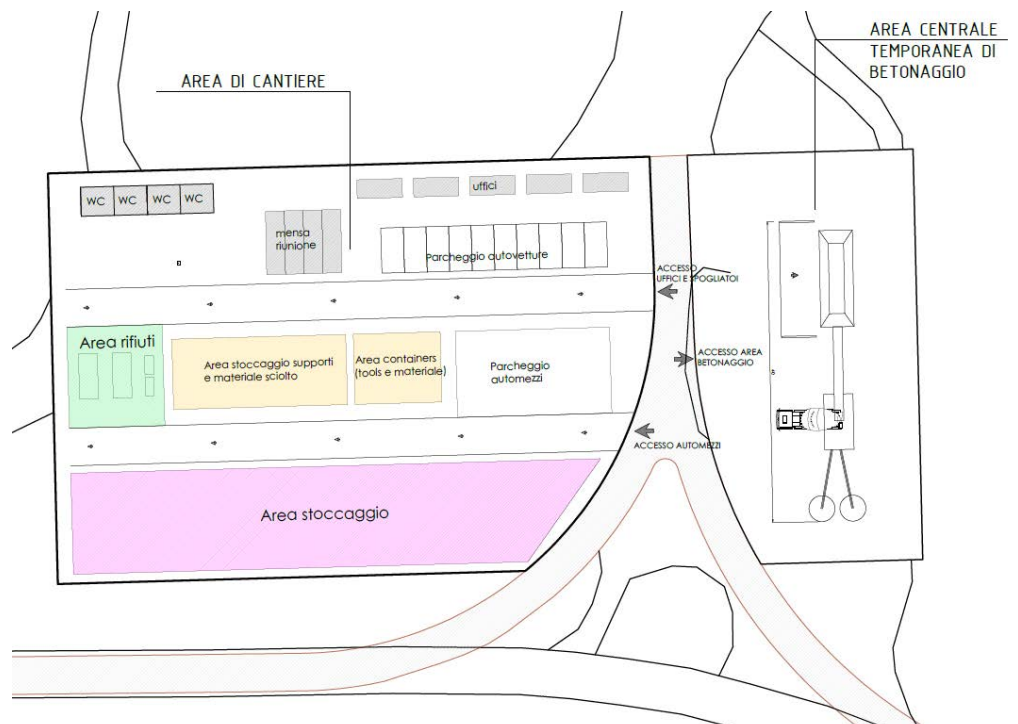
Allestimento area di accantieramento e centrale temporanea di betonaggio
